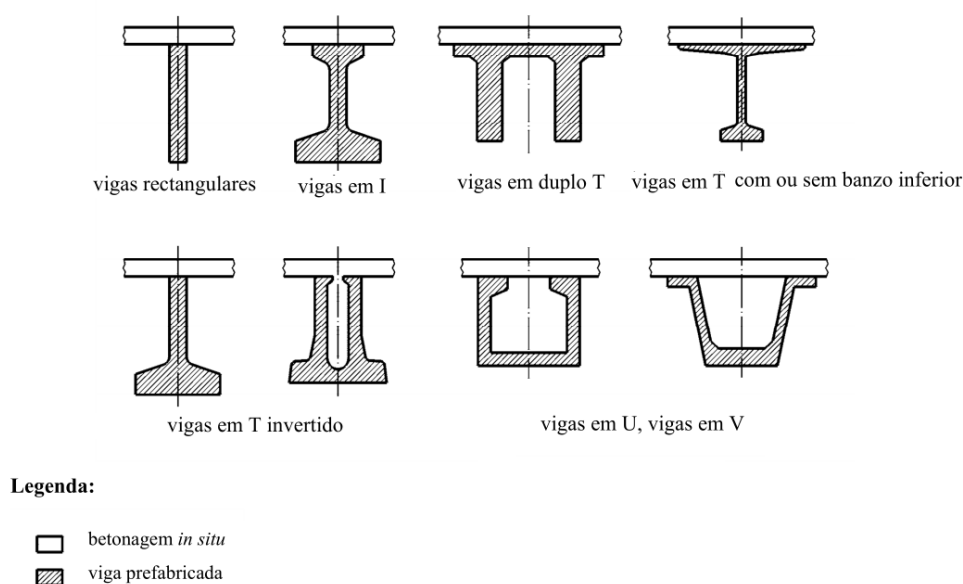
Exemplos de secções transversais pré-fabricadas sob betonagem *in situ* (NP EN 15050, 2008).
